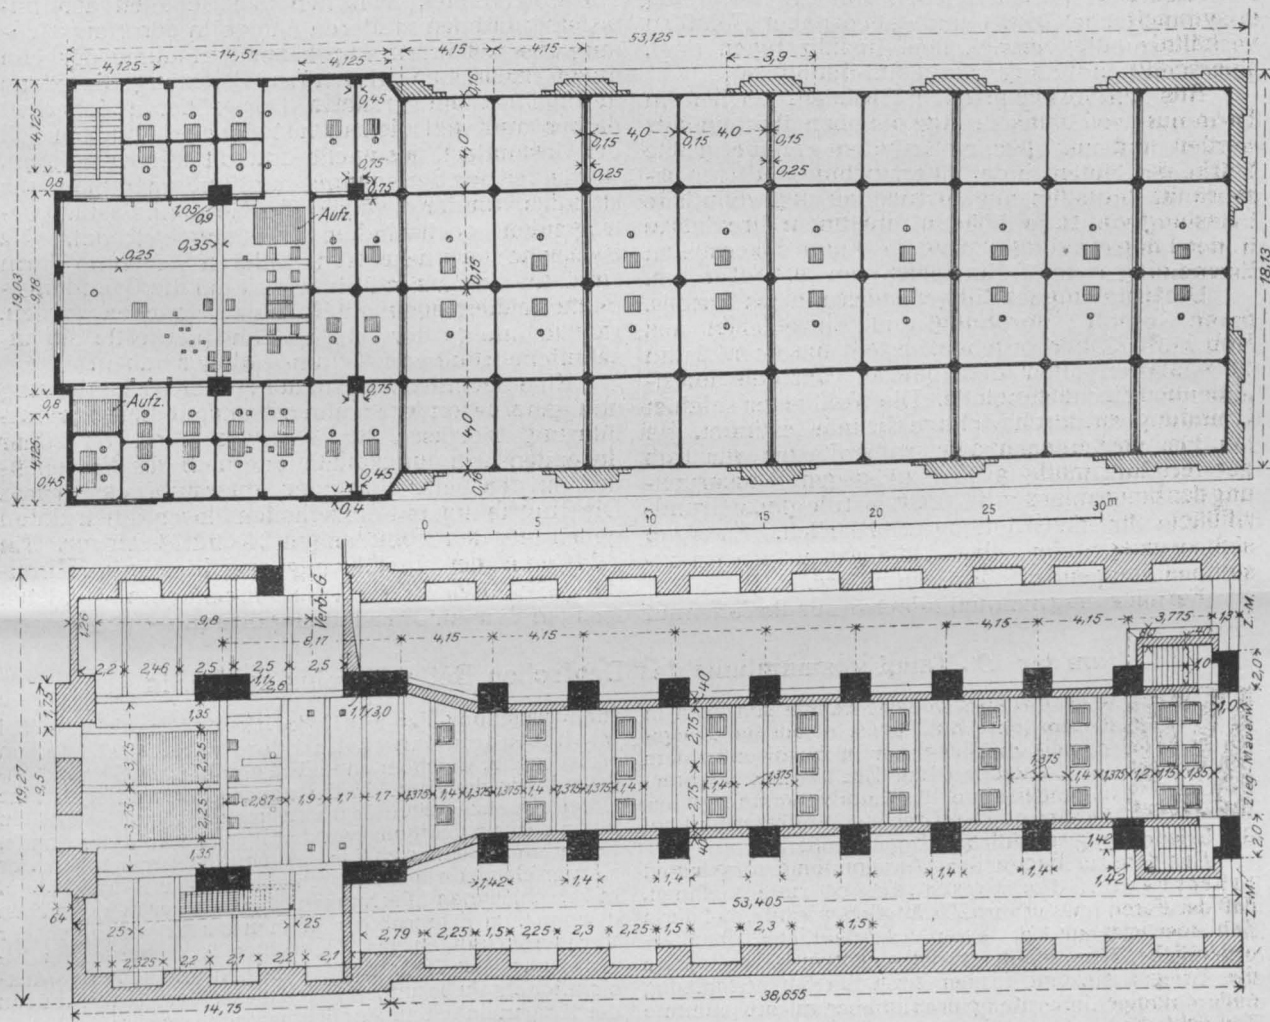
und 25b. Grundrisse des Silogebäudes, Untergeschoß (unten) und 7. Boden.
